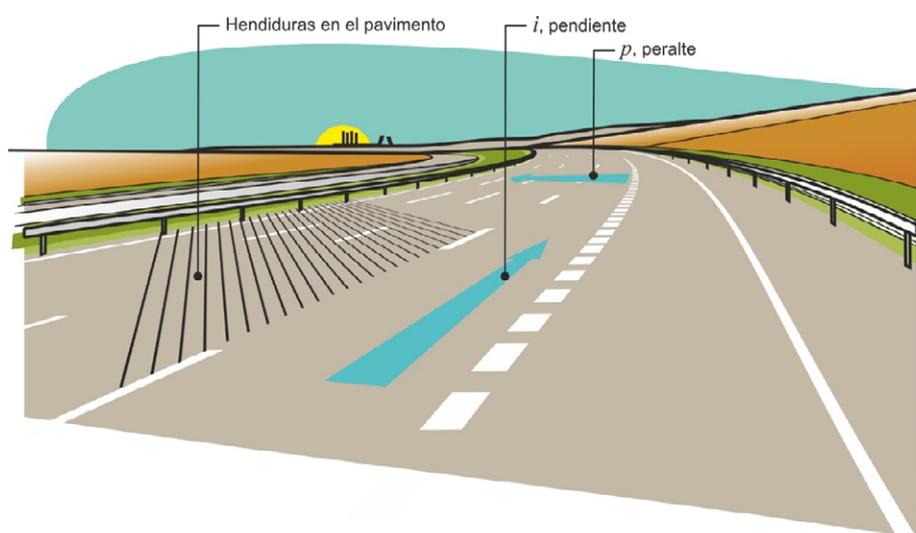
EJEMPLO DE HENDIDURAS EN EL PAVIMENTO DE UNA PLATAFORMA DE GRAN ANCHURA
